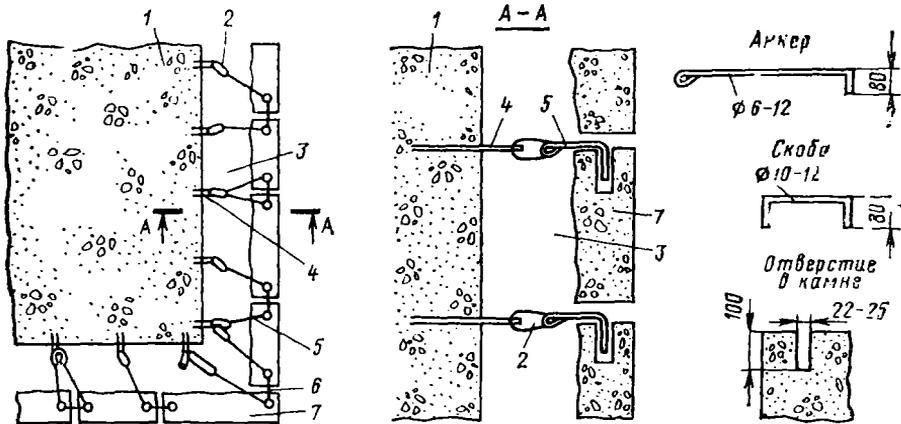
Крепление навесной облицовки к бетонной опоре:
